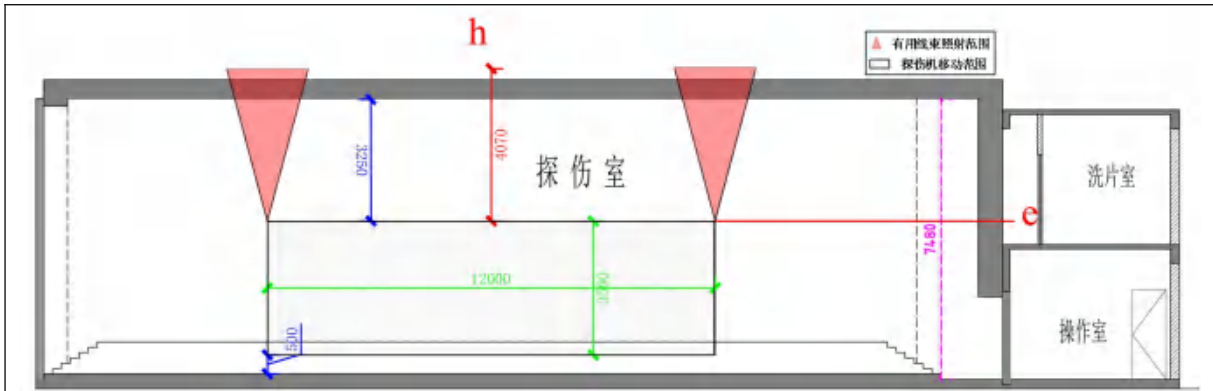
探伤室关注点位示意图（南北方向剖面图，单位：mm）
